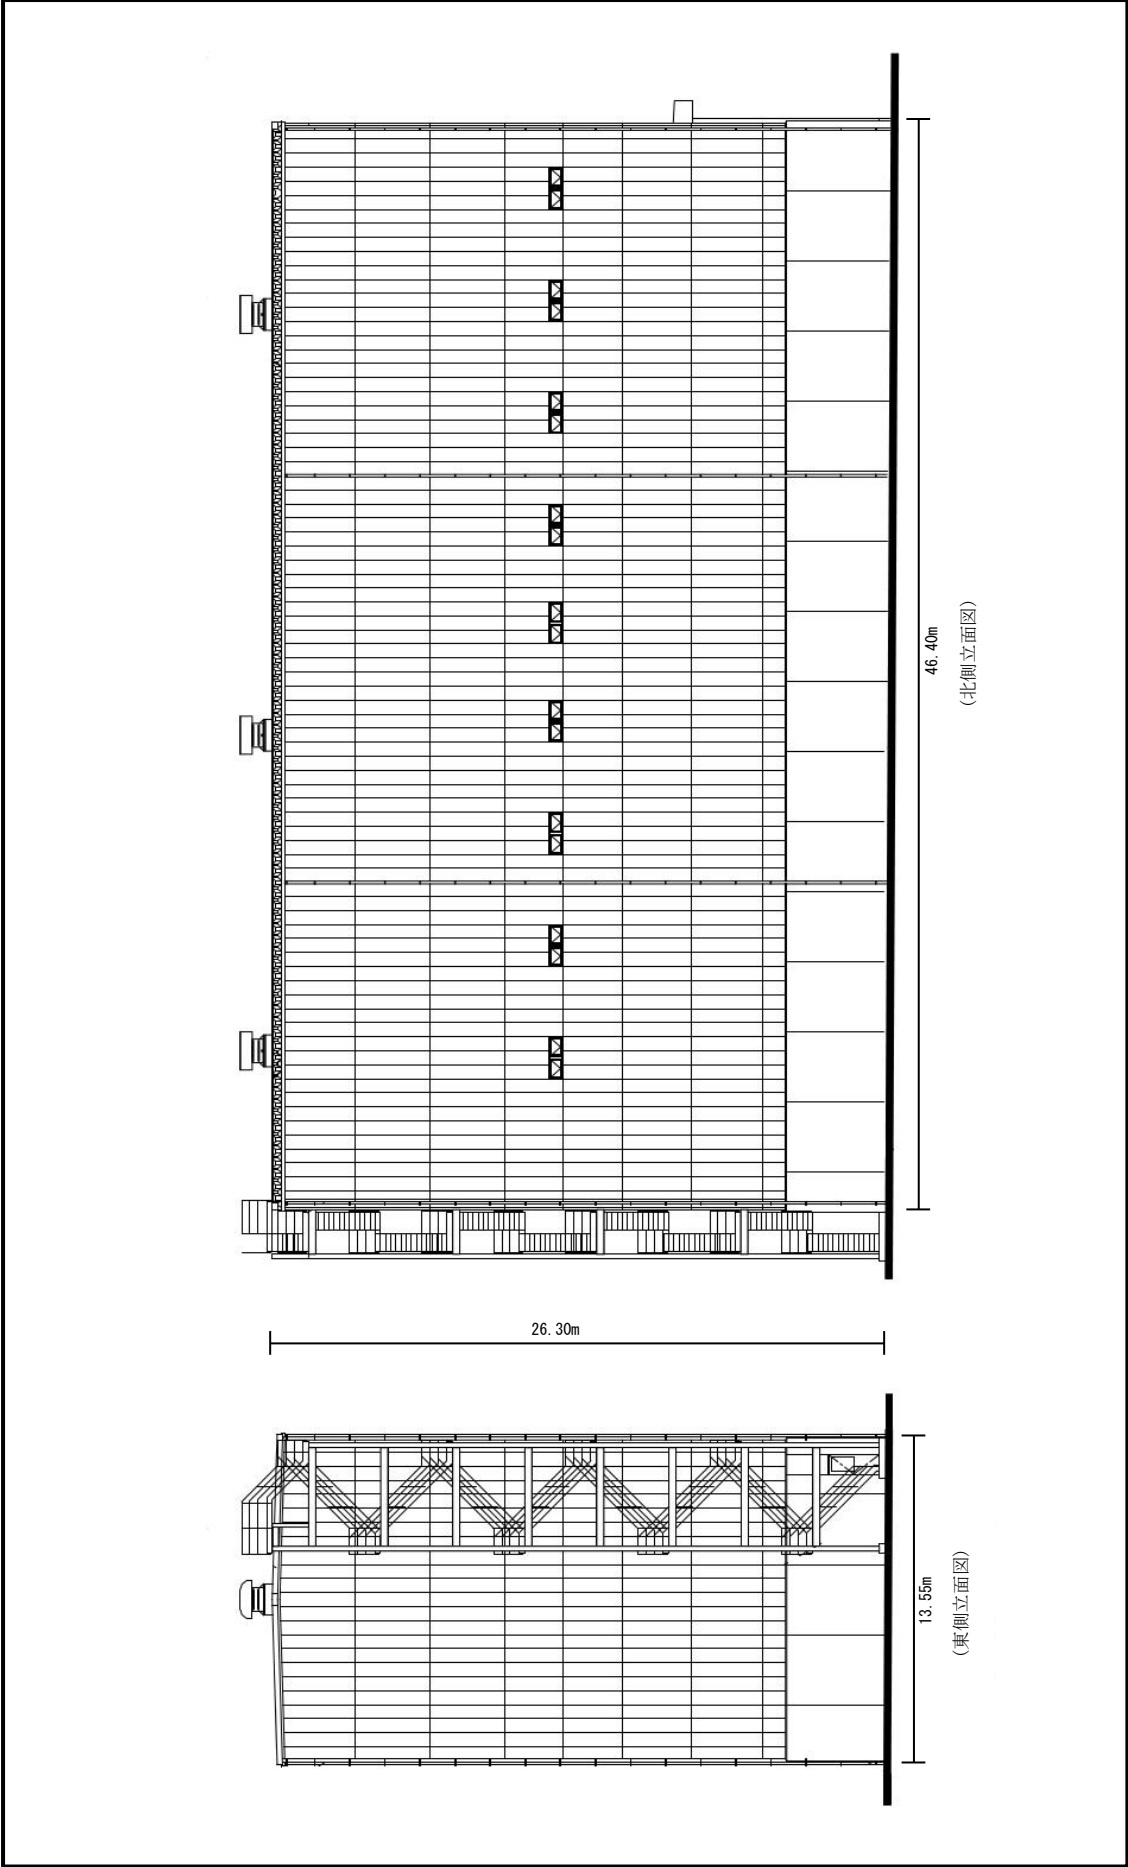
(3) 施設建屋立面図-2 (東・北立面)
